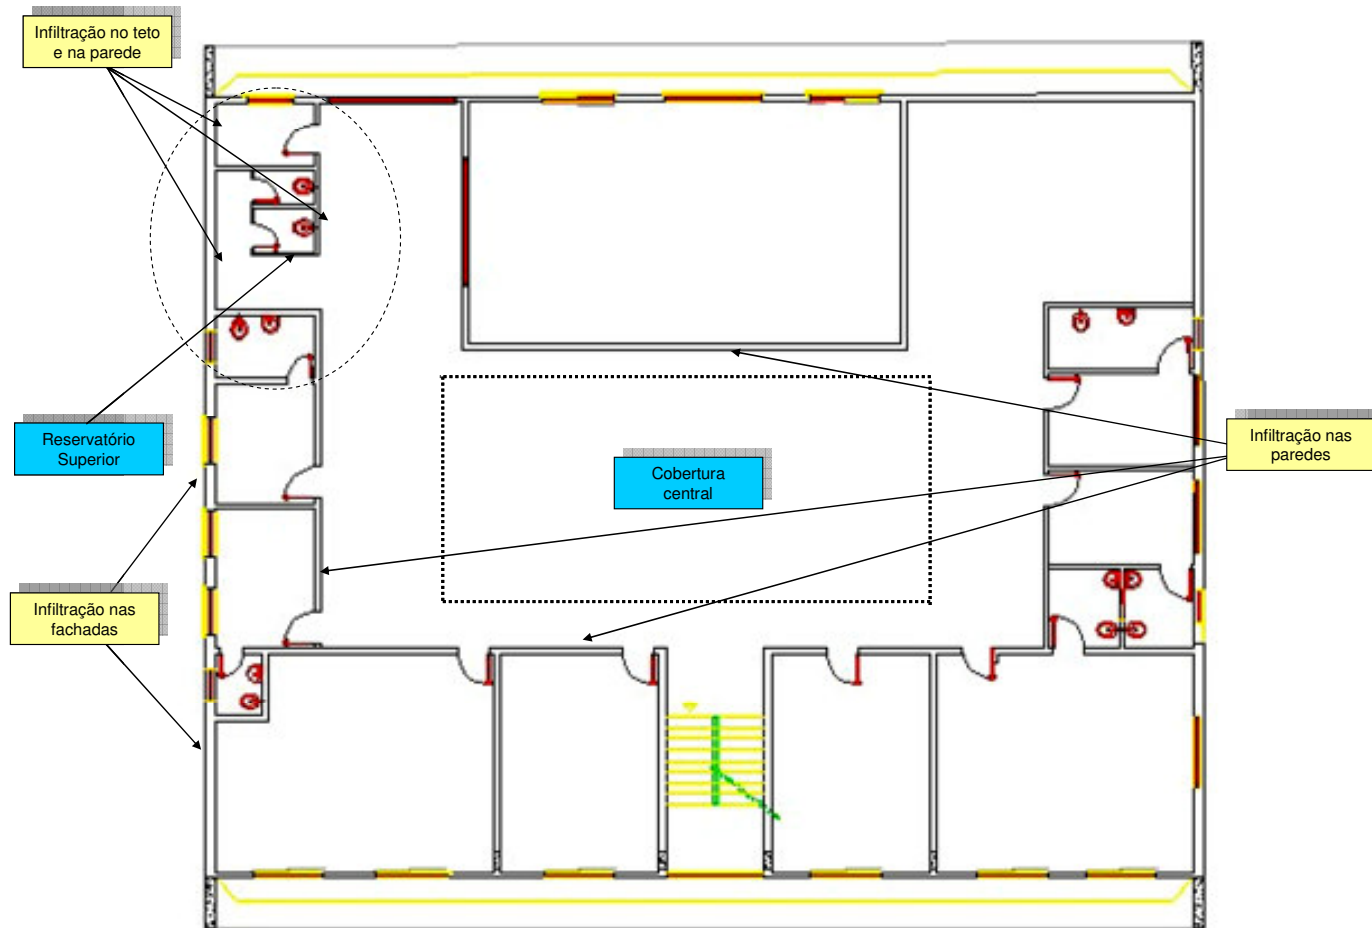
Planta do 1º pavimento e suas patologias.
